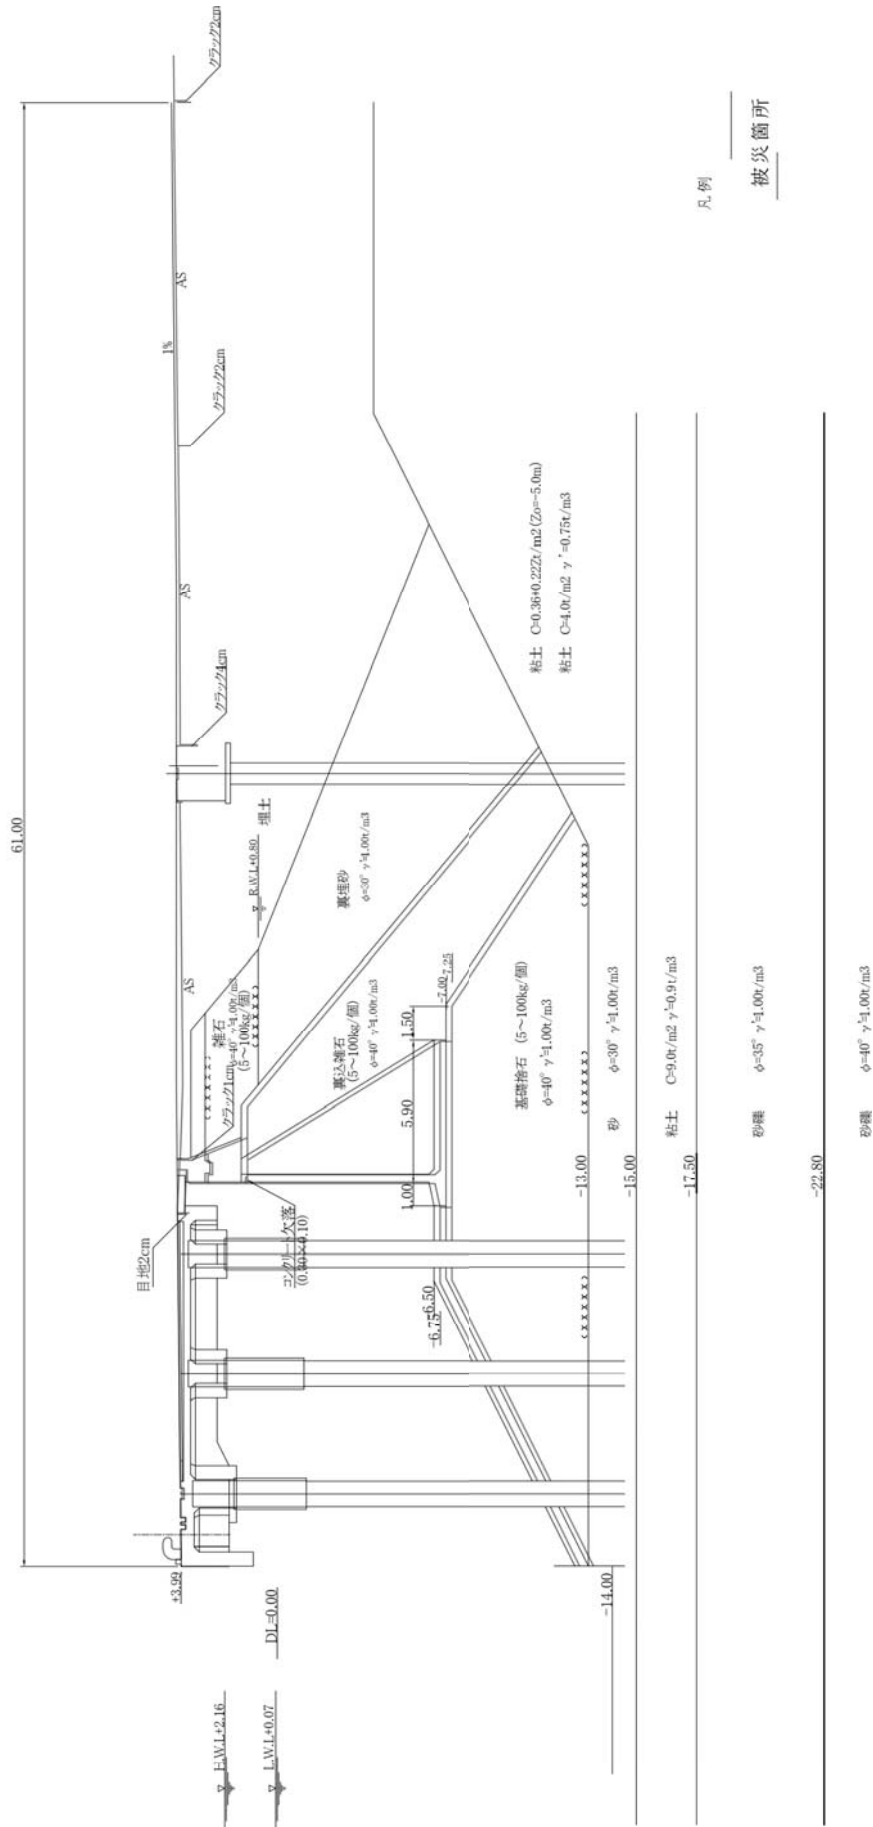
アイランドシティ地区-14m 栈橋の被災状況断面図
